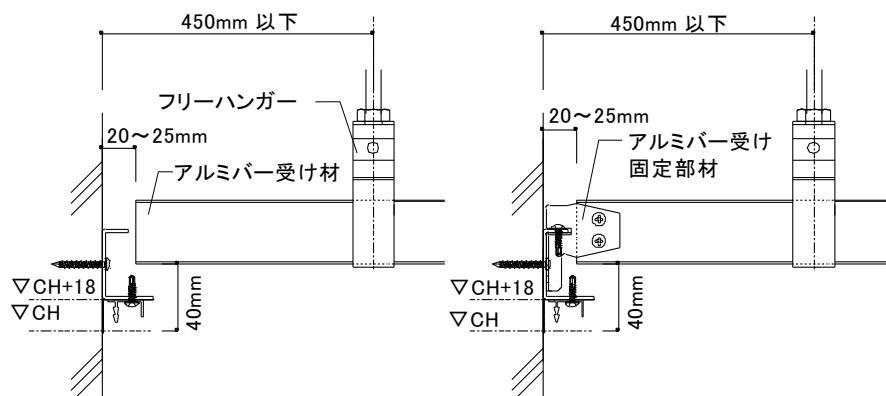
アルミバー受け固定部材の施工手順(壁面が RC の場合)
